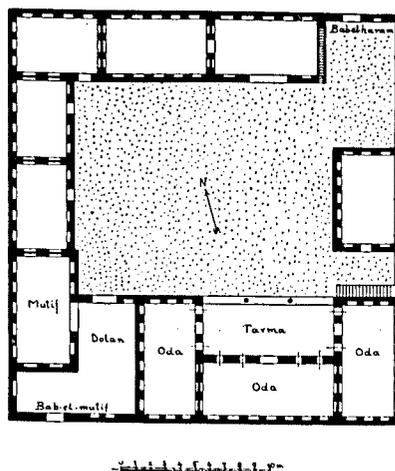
Haus des Dschessâm, Koweiresch. Grundriß.
